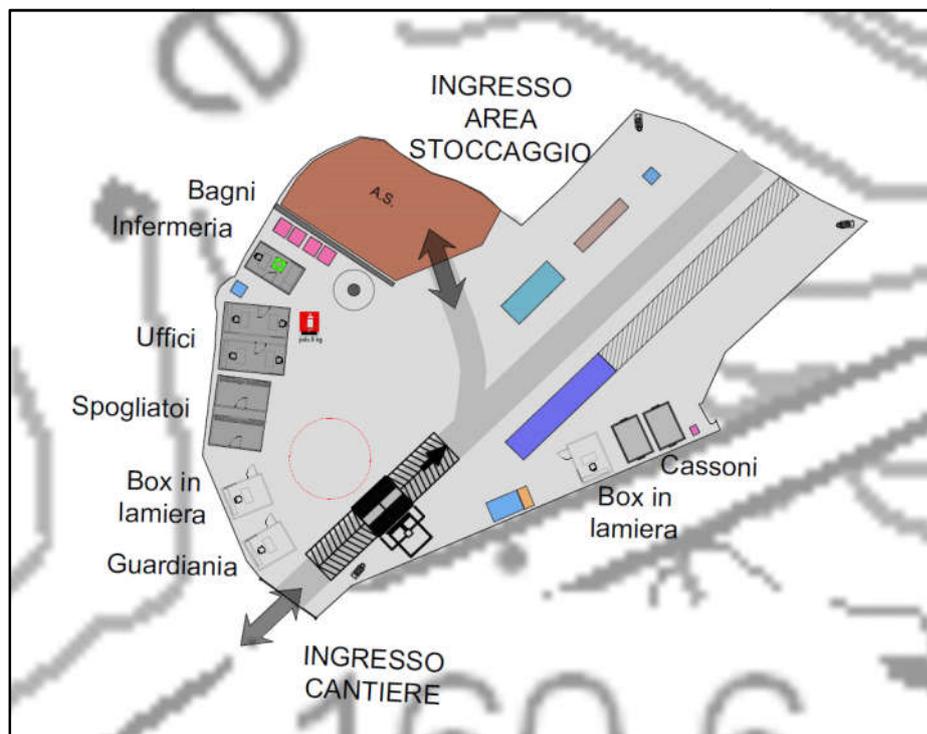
Layout cantiere operativo all'imbocco sud (CO 01)
